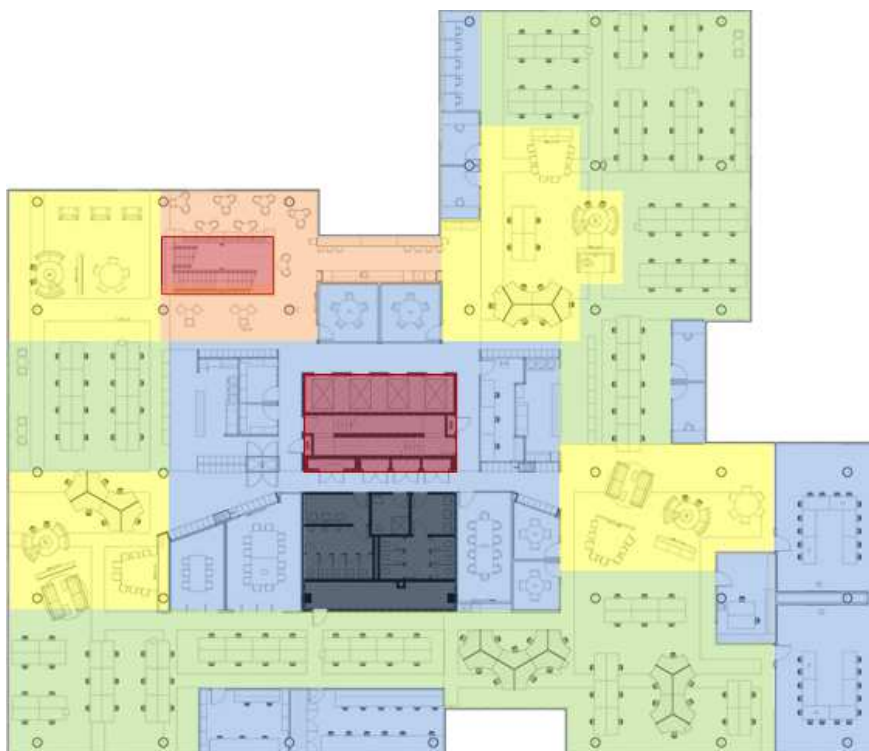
Planta baixa do terceiro pavimento editada pela autora.
